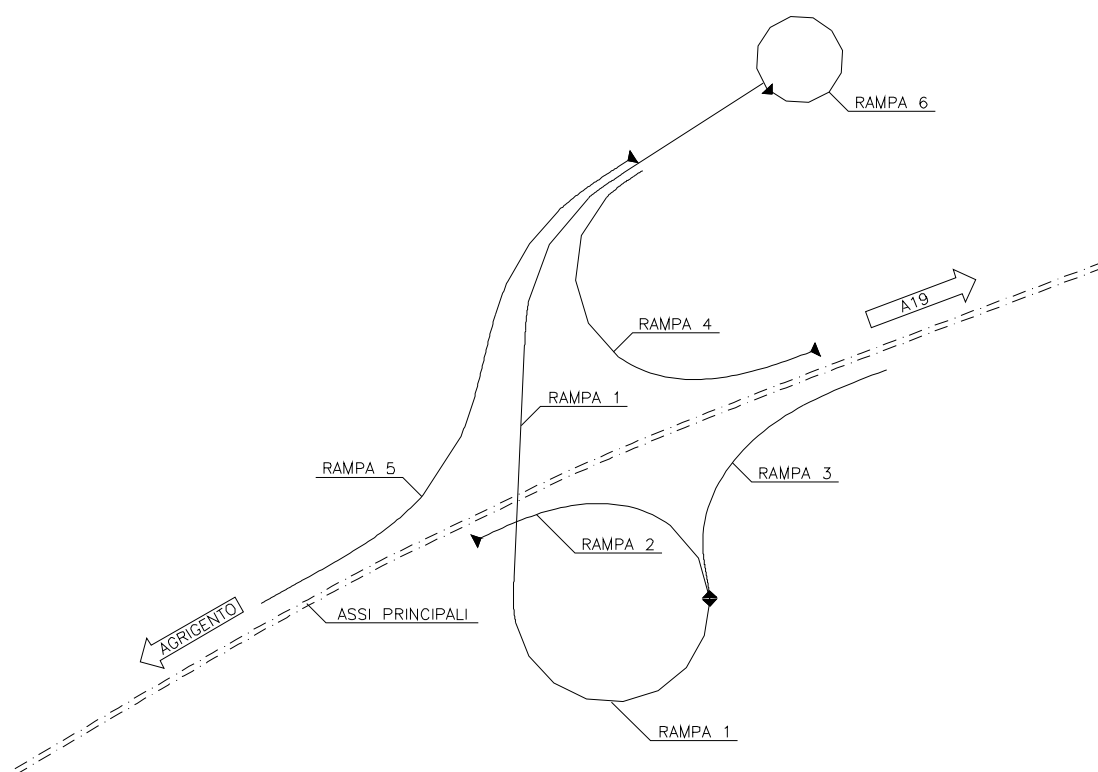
Svincolo Serradifalco - Planimetria schematica
